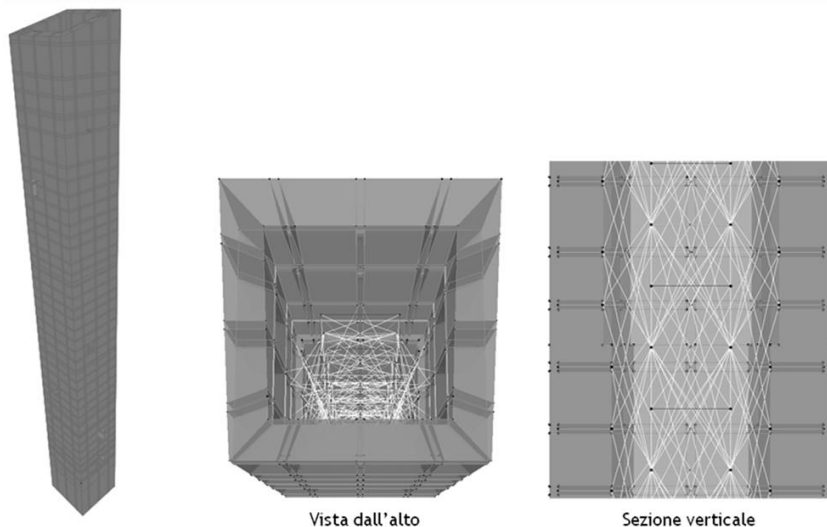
Modello FEM della torre San Dalmazio con traliccio interno e pendini inclinati
